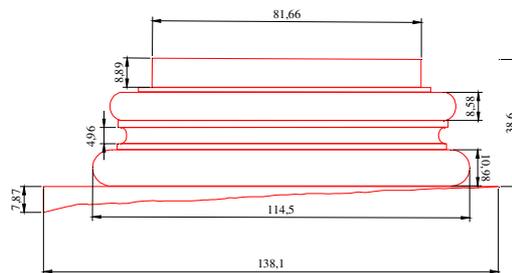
base colonna sud, foto e prospetto di Alessandra Iodice.
